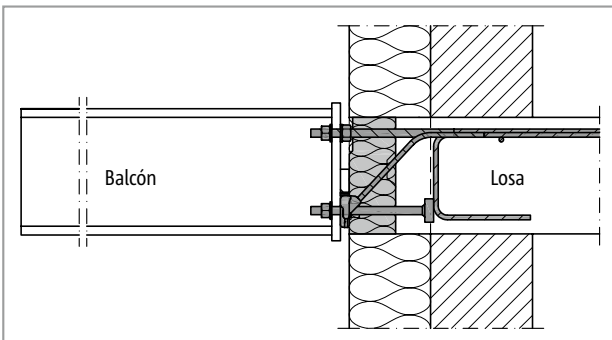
Schöck Isokorb® T tipo SK: Con ayuda del saliente de la losa, el elemento aislante cierra al ras con el aislamiento del muro. Aquí se deberán tener en cuenta las distancias laterales al borde
